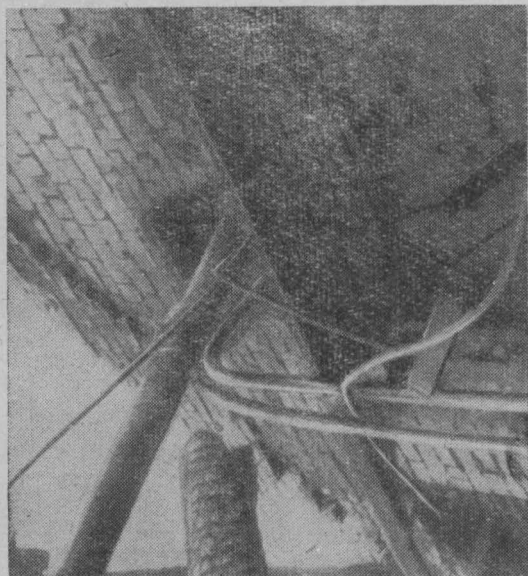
Брандмауэр, отделявший стену клуба от подсобных помещений. В центре виден монтажный проем.
